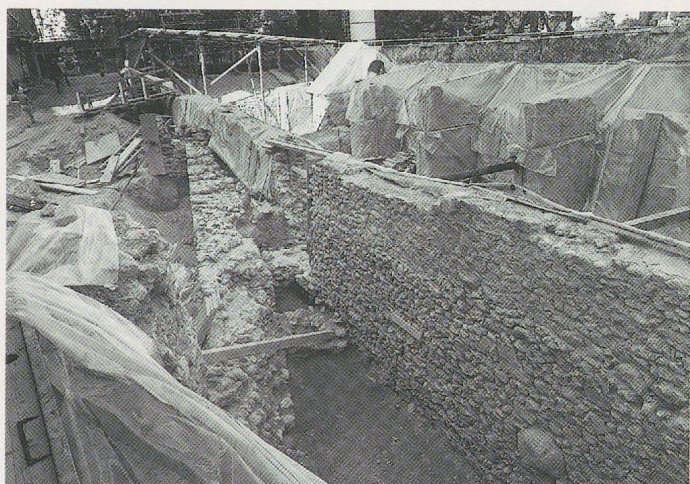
Terrasse ouest, le premier mur de terrasse II¹ et le mur provisoire de retenue VII¹⁰.
